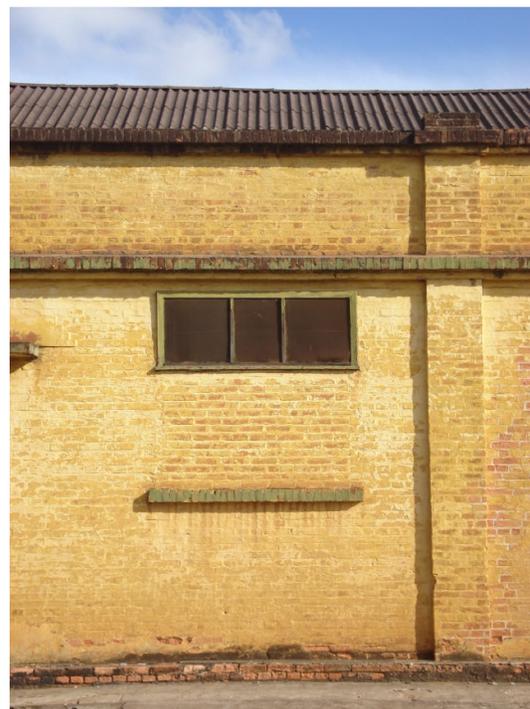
Fachada a partir da rua dos Operários.
